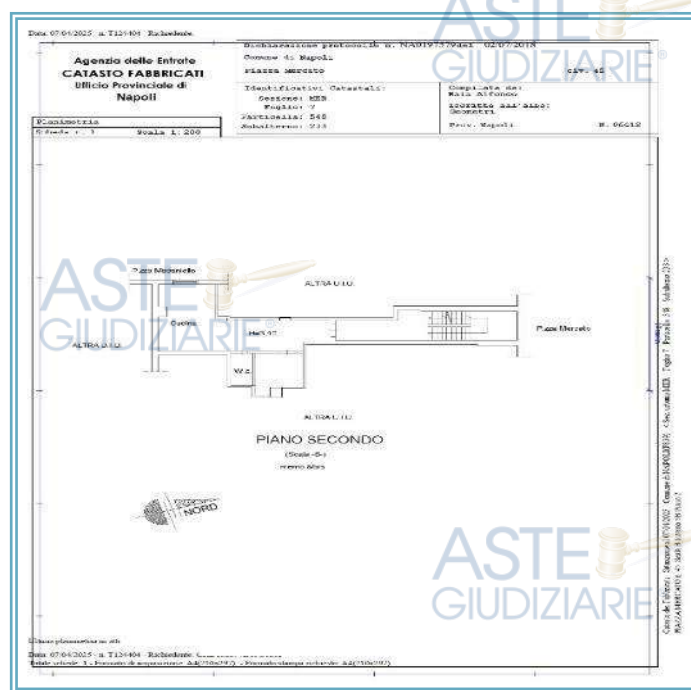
Pianta catastale attuale – Piano Secondo (LOTTO 8b)
